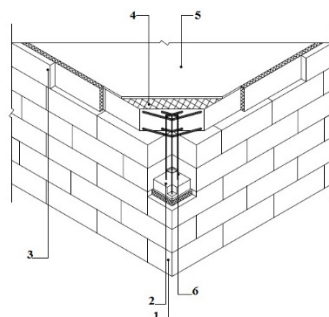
Вариант устройства монолитных колонн в углах зданий для сейсмоопасных регионов: 1 — блоки YTONG; 2 — тяжелый бетон; 3 — доборный блок; 4 — металлическая сетка 40x40 мм; 5 — монолитное межэтажное перекрытие; 6 — армирующий каркас (4 стержня Ø 8–12 мм)
